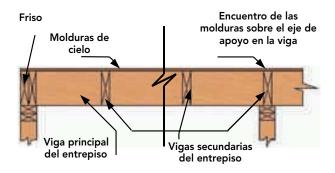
Corte de entrepiso que muestra las molduras apoyadas y fijadas sobre el envigado, quedando las vigas a la vista. Sobre éstas se debe considerar la base para la solución de pavimento y aislación acústica.
